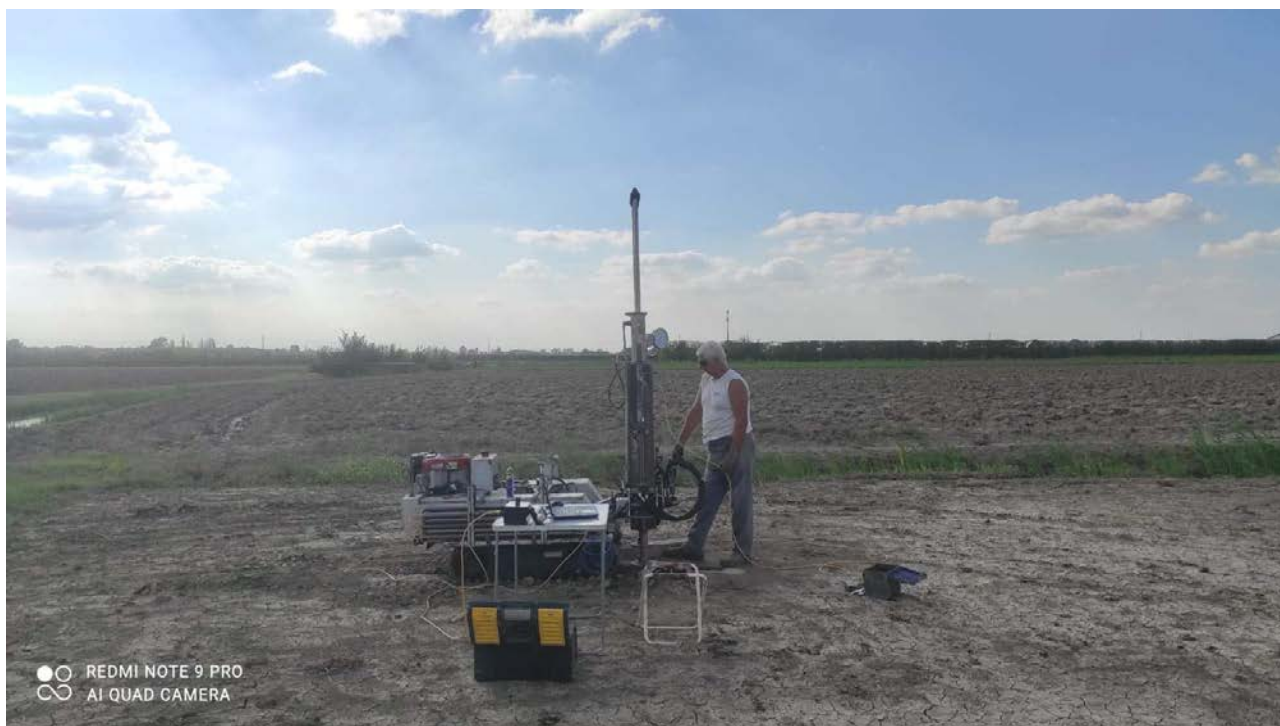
ubicazione prova CPTU 3 (altra angolazione)
